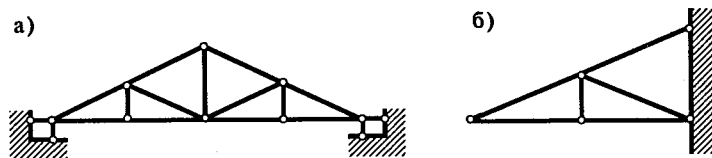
Примеры простейших стержневых систем: а) балочная ферма; б) консольная ферма
